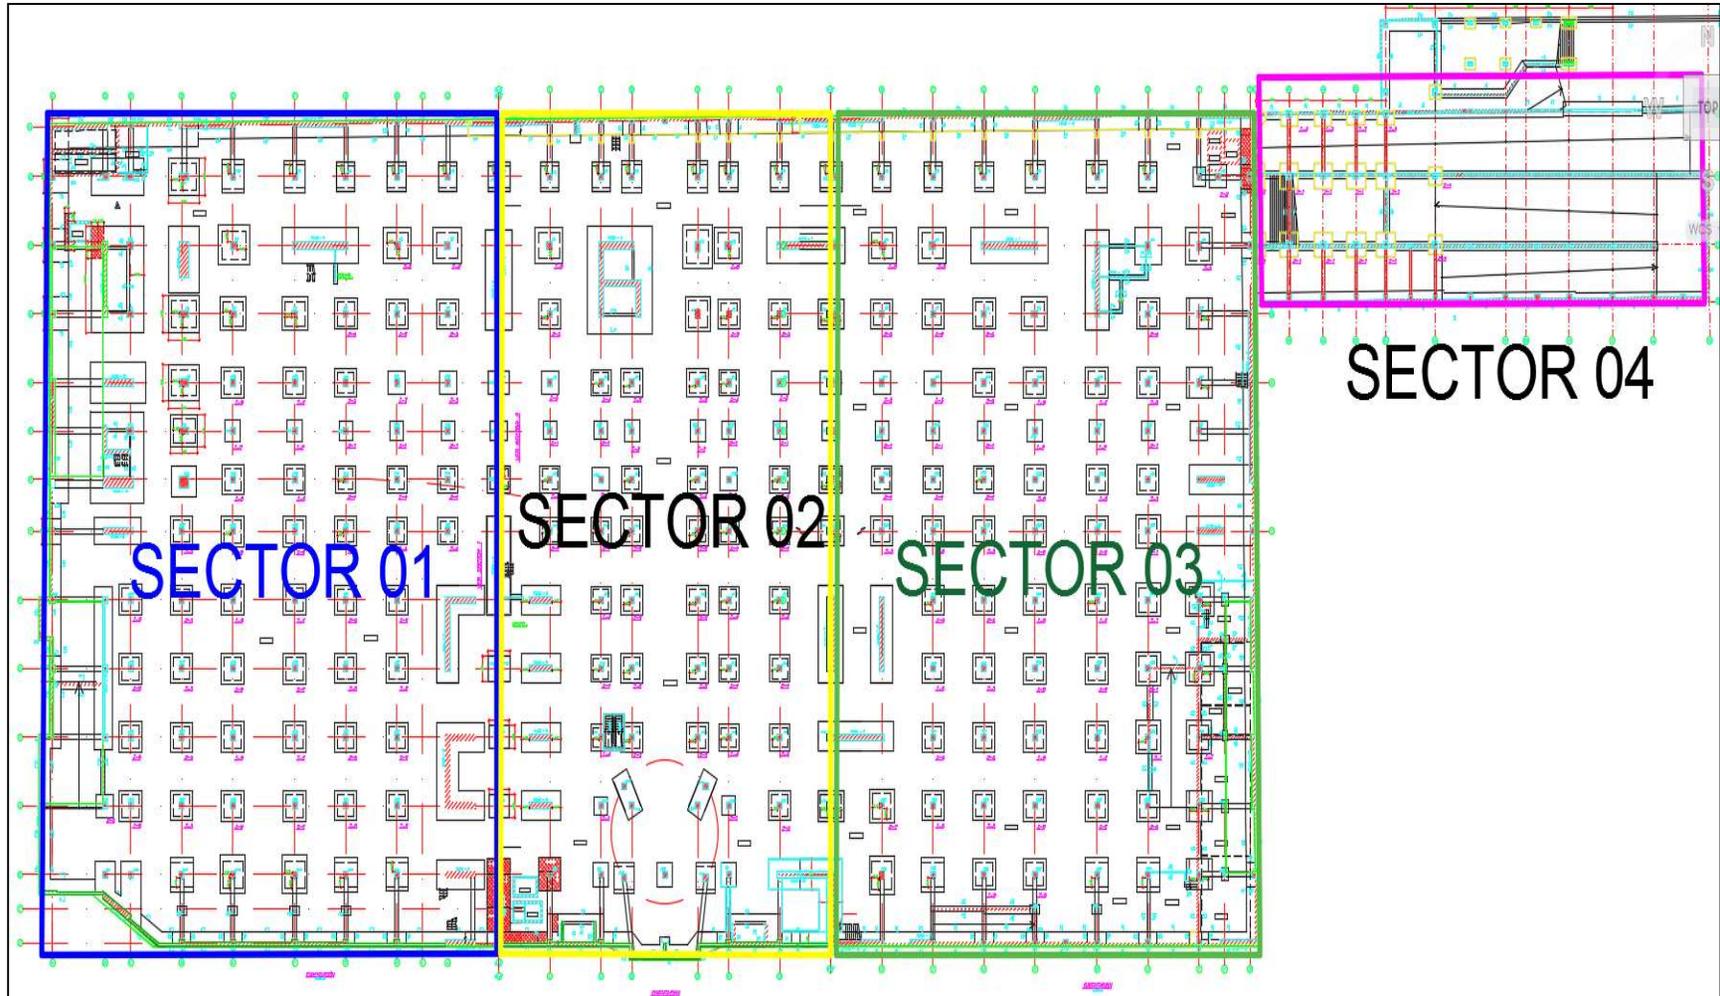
Sectorización para Ejecución de Obra – Mall Aventura Plaza “Santa Anita” - Elaboración Propia
